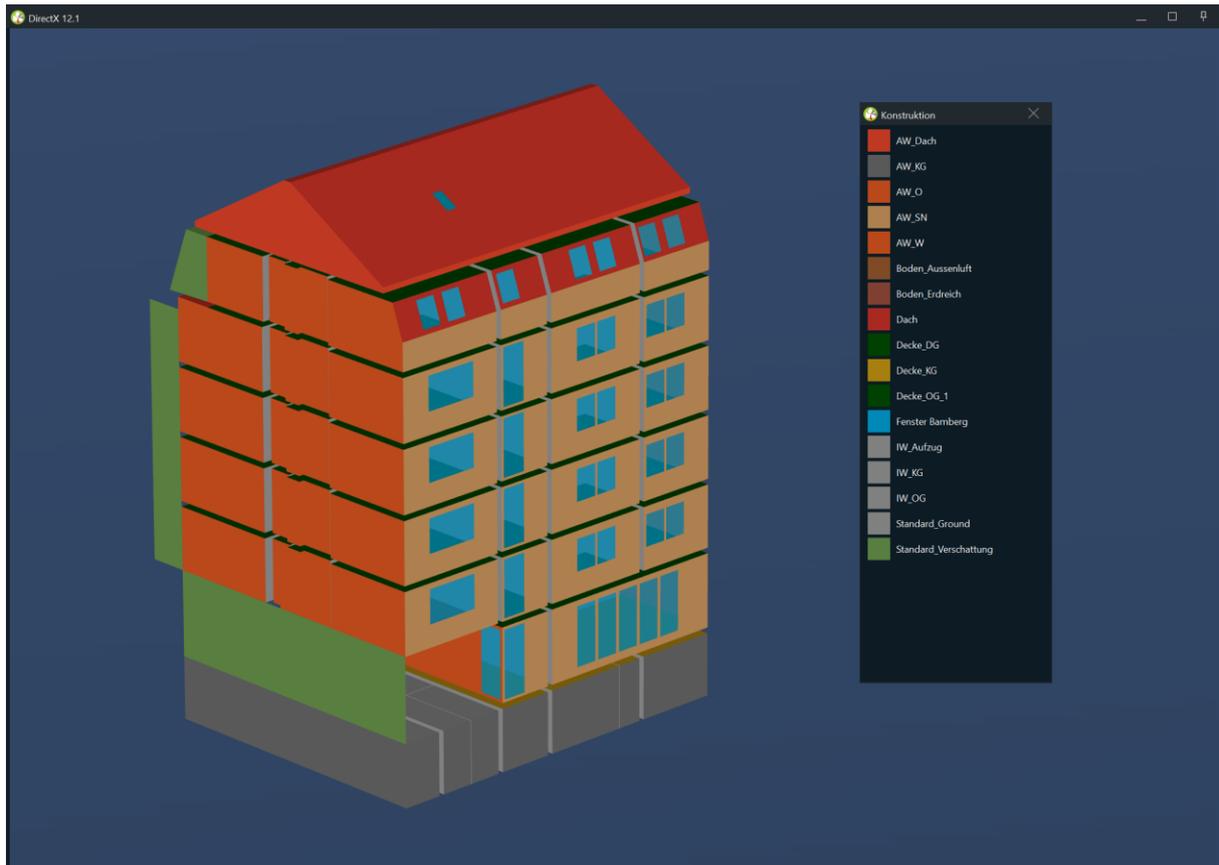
Straßenansicht detailliertes Gebäudemodell Variante 1
